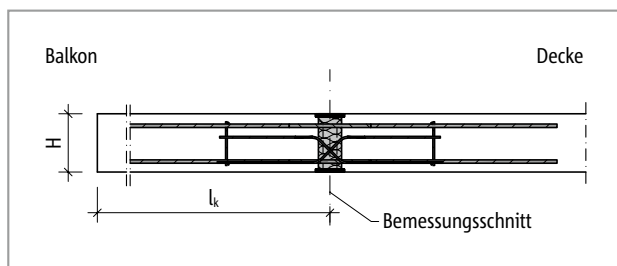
Schöck Isokorb® T Typ D: Statisches System
